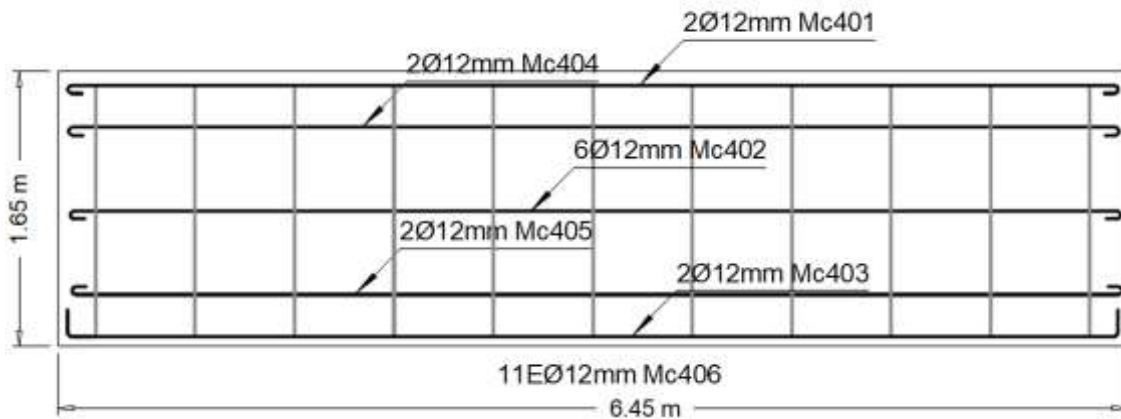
Corte longitudinal del diafragma para puentes losa sobre vigas.
